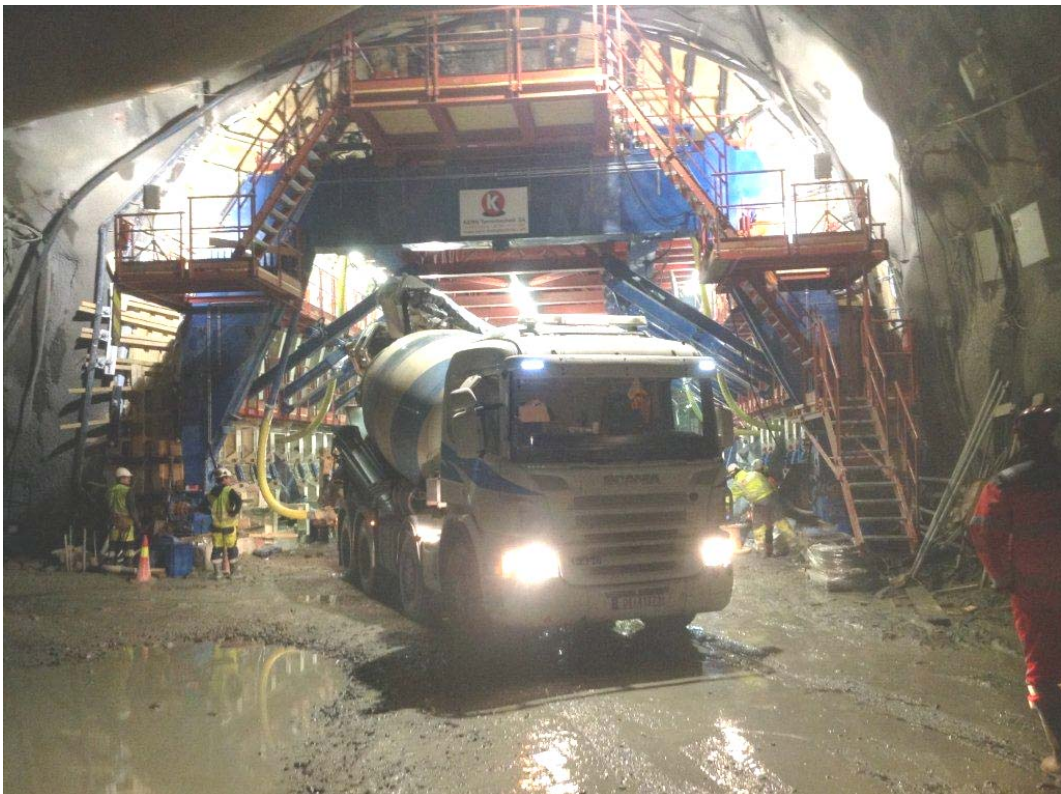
Tunnel sikret og utjevnet med sprøytebetong før membranmontering. Fellesprosjektet E6-Dovrebanen
